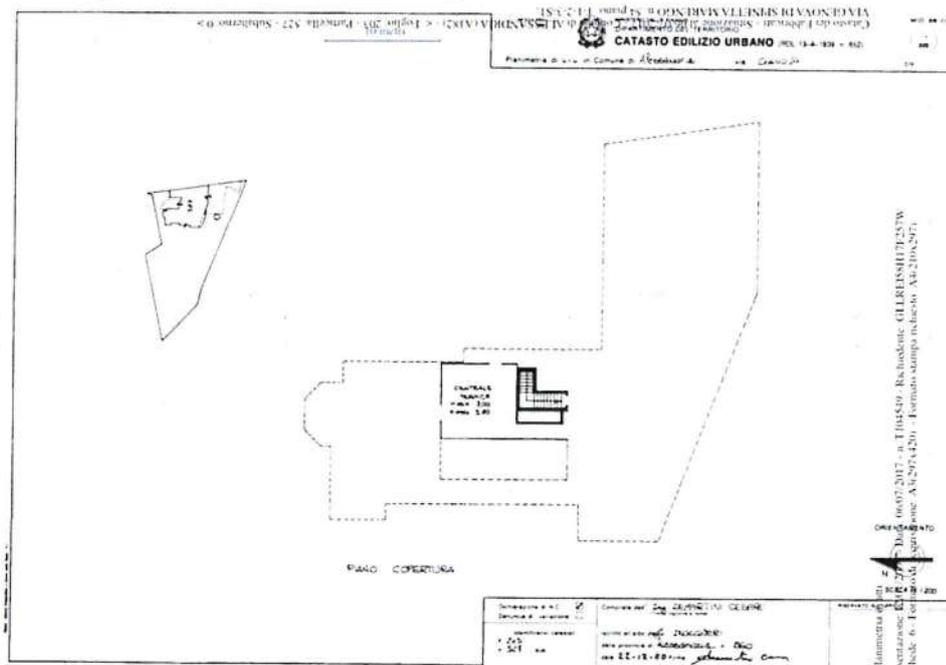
Part. 527 - Pianta piano copertura (5° F.T.)
